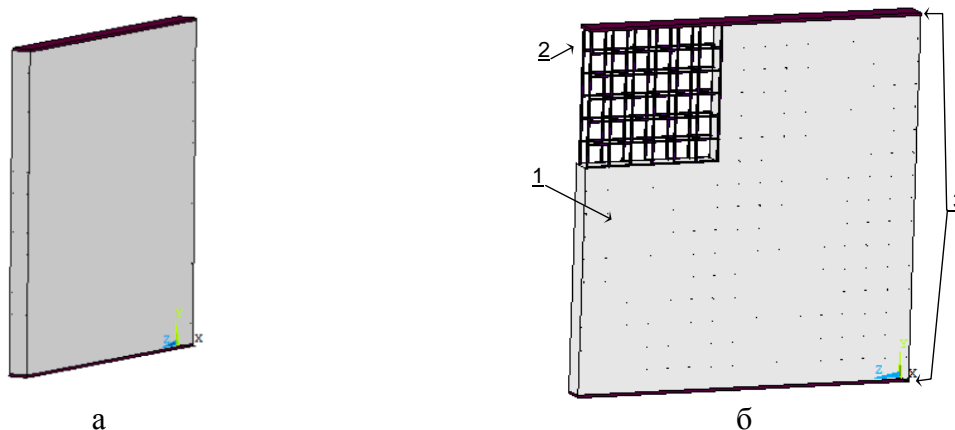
Схема расчетной области железобетонной несущей стены для проведения расчета предела огнестойкости (а – общий вид, который используют для вычислительного эксперимента, б – схема армирования) 1 – бетон, 2 – рабочий арматурный каркас: $d = 16$ мм, 3 – траверсы нагрузочной рамы
